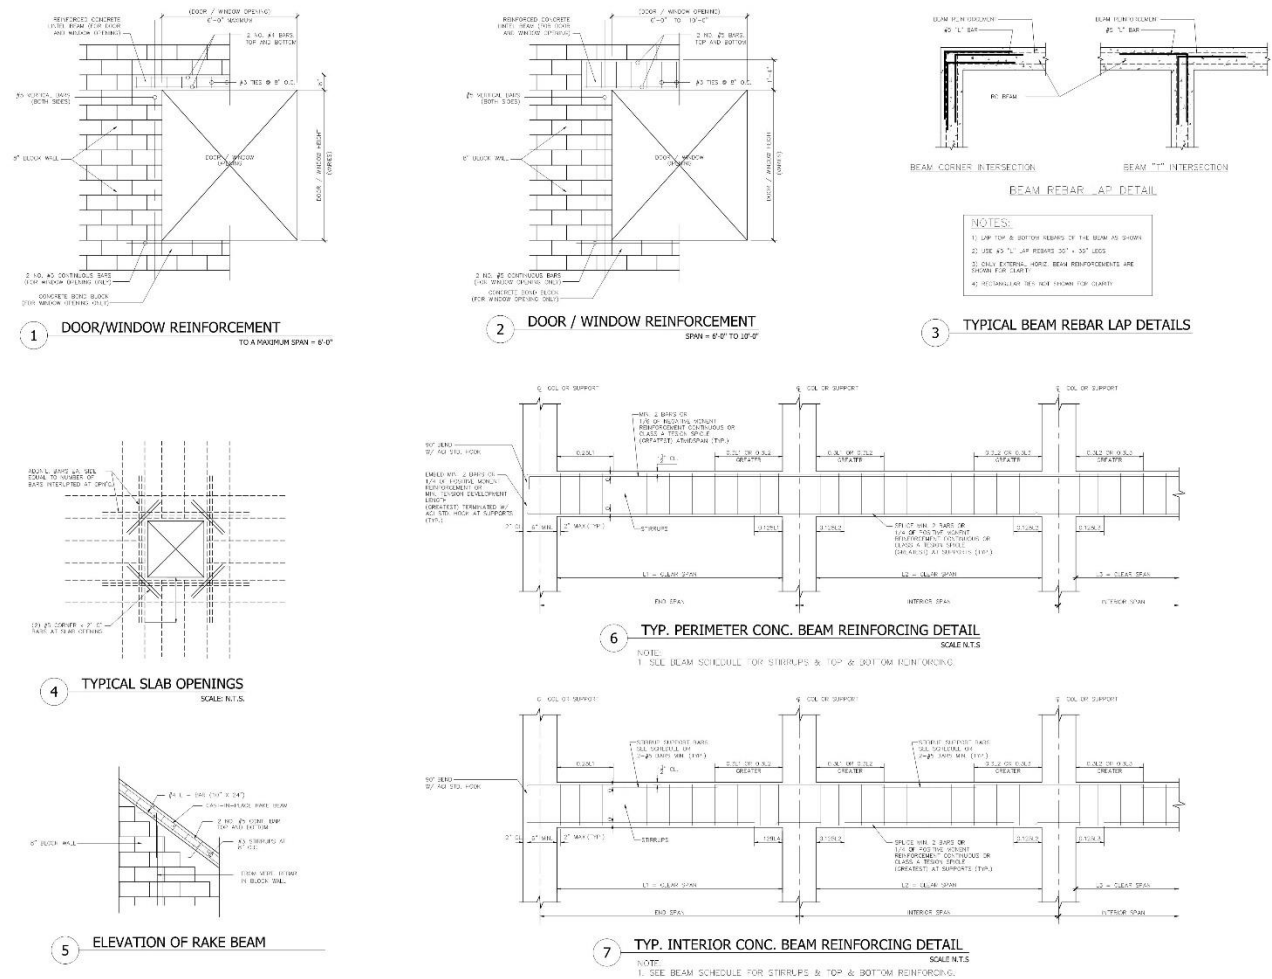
Detalles de refuerzo alrededor de puertas y ventanas, detalles de vigas, aberturas en las placas, elevación de vigas inclinada, detalles típicos de refuerzo de vigas interiores.
